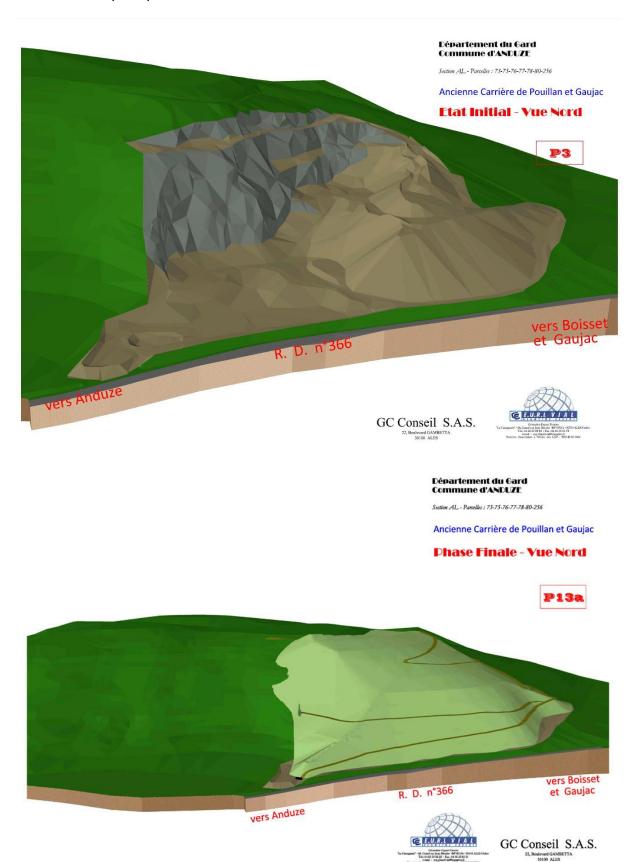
vues 3D de la zone avant et après comblement par le projet
